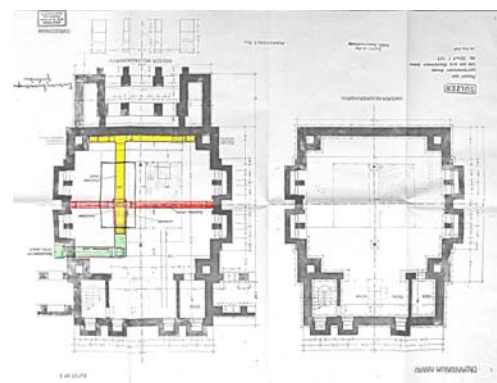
Albert Froelich, Grundriss 1. und 2. Untergeschoss
